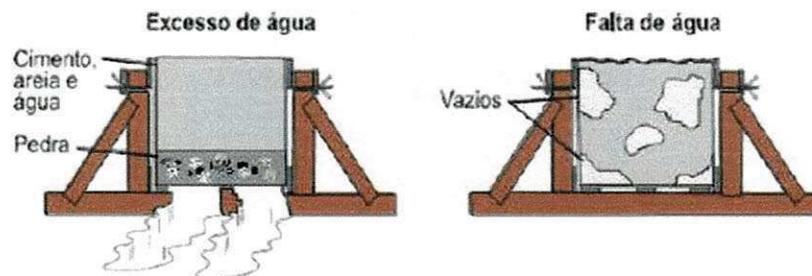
Concreto mal dosado, ou lançado incorretamente ou não adensado suficientemente
